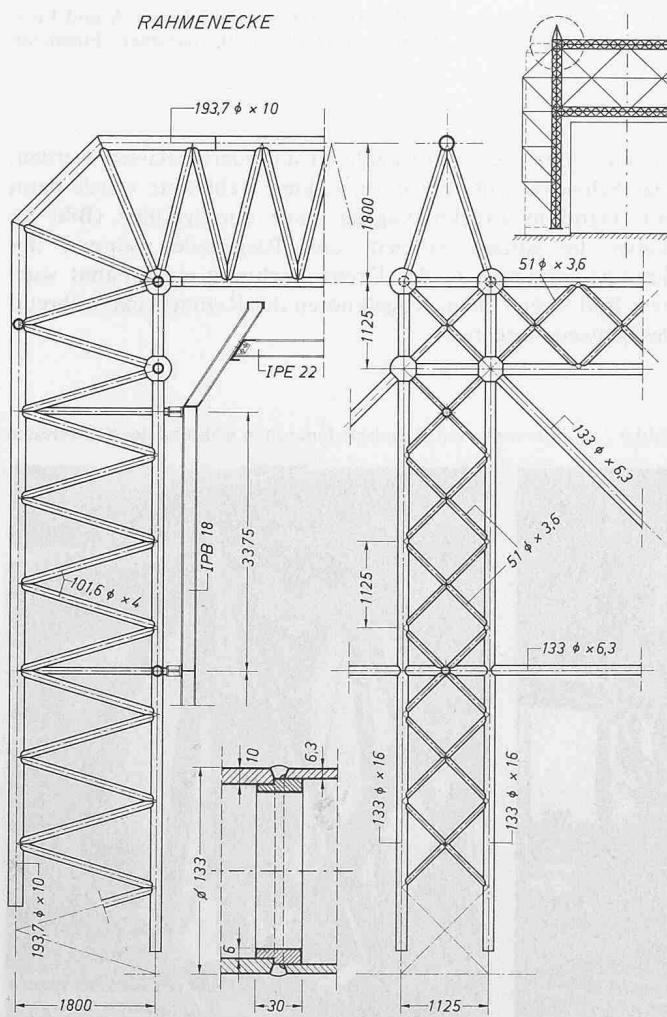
Konstruktionsdetail der oberen Rahmenecke mit Wand- und Deckenanschluss, Massstab 1:500
